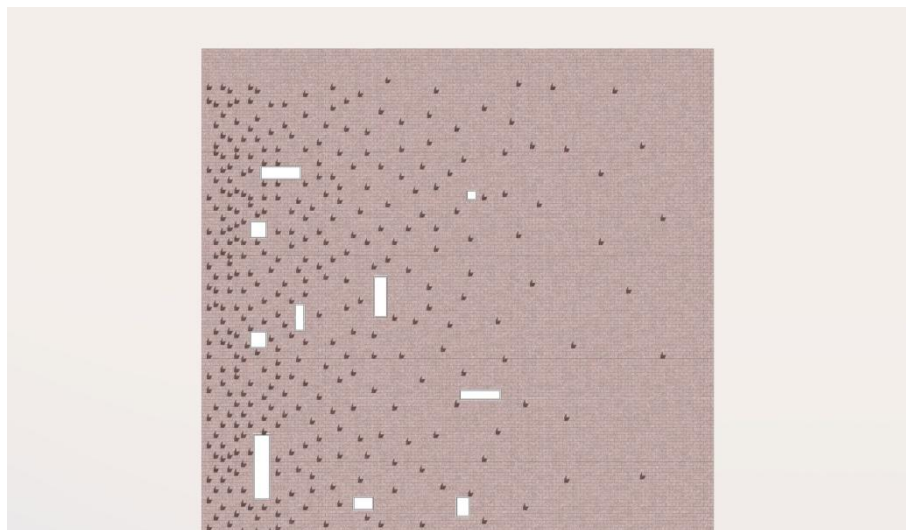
ALÇADO ESTE - REMATE DA TORRE - PROJEÇÃO DA SOMBRA DO TIJOLO NA FACHADA
